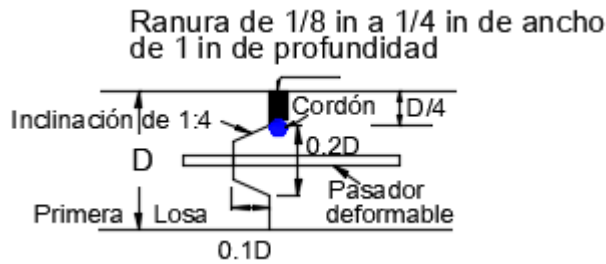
Junta longitudinal con plato deformable en junta.
